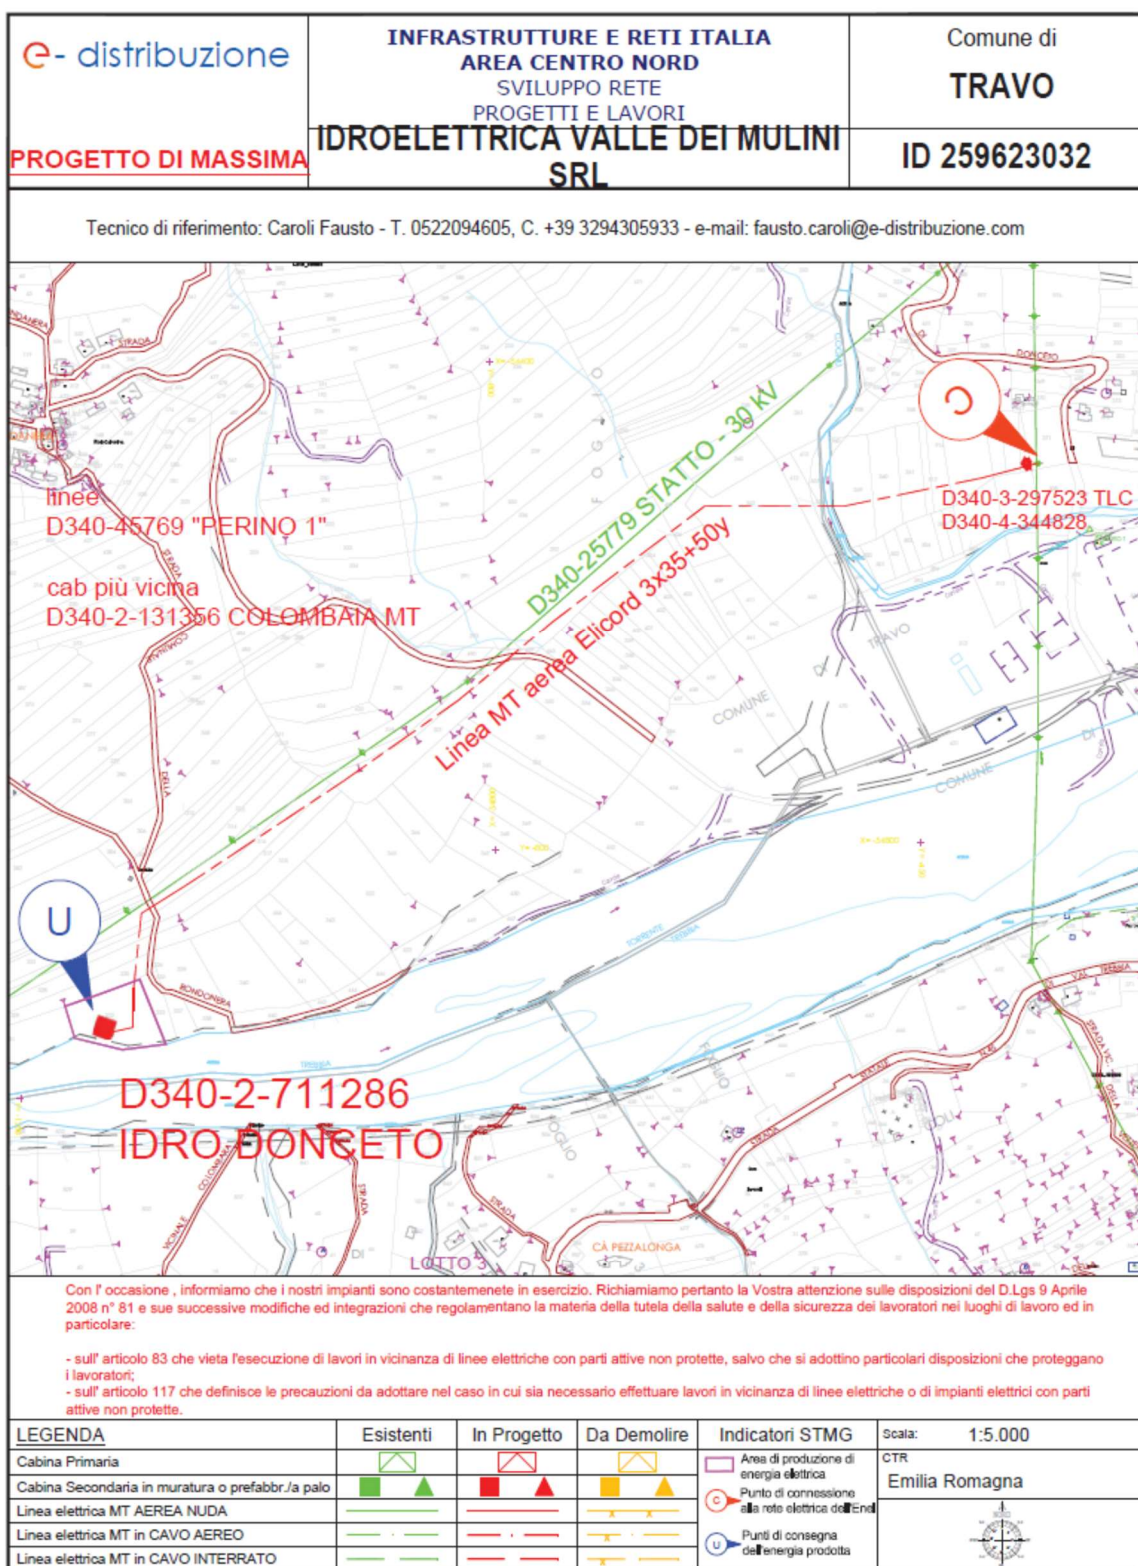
Estratto planimetrico progetto di massima preventivo di connessione.
